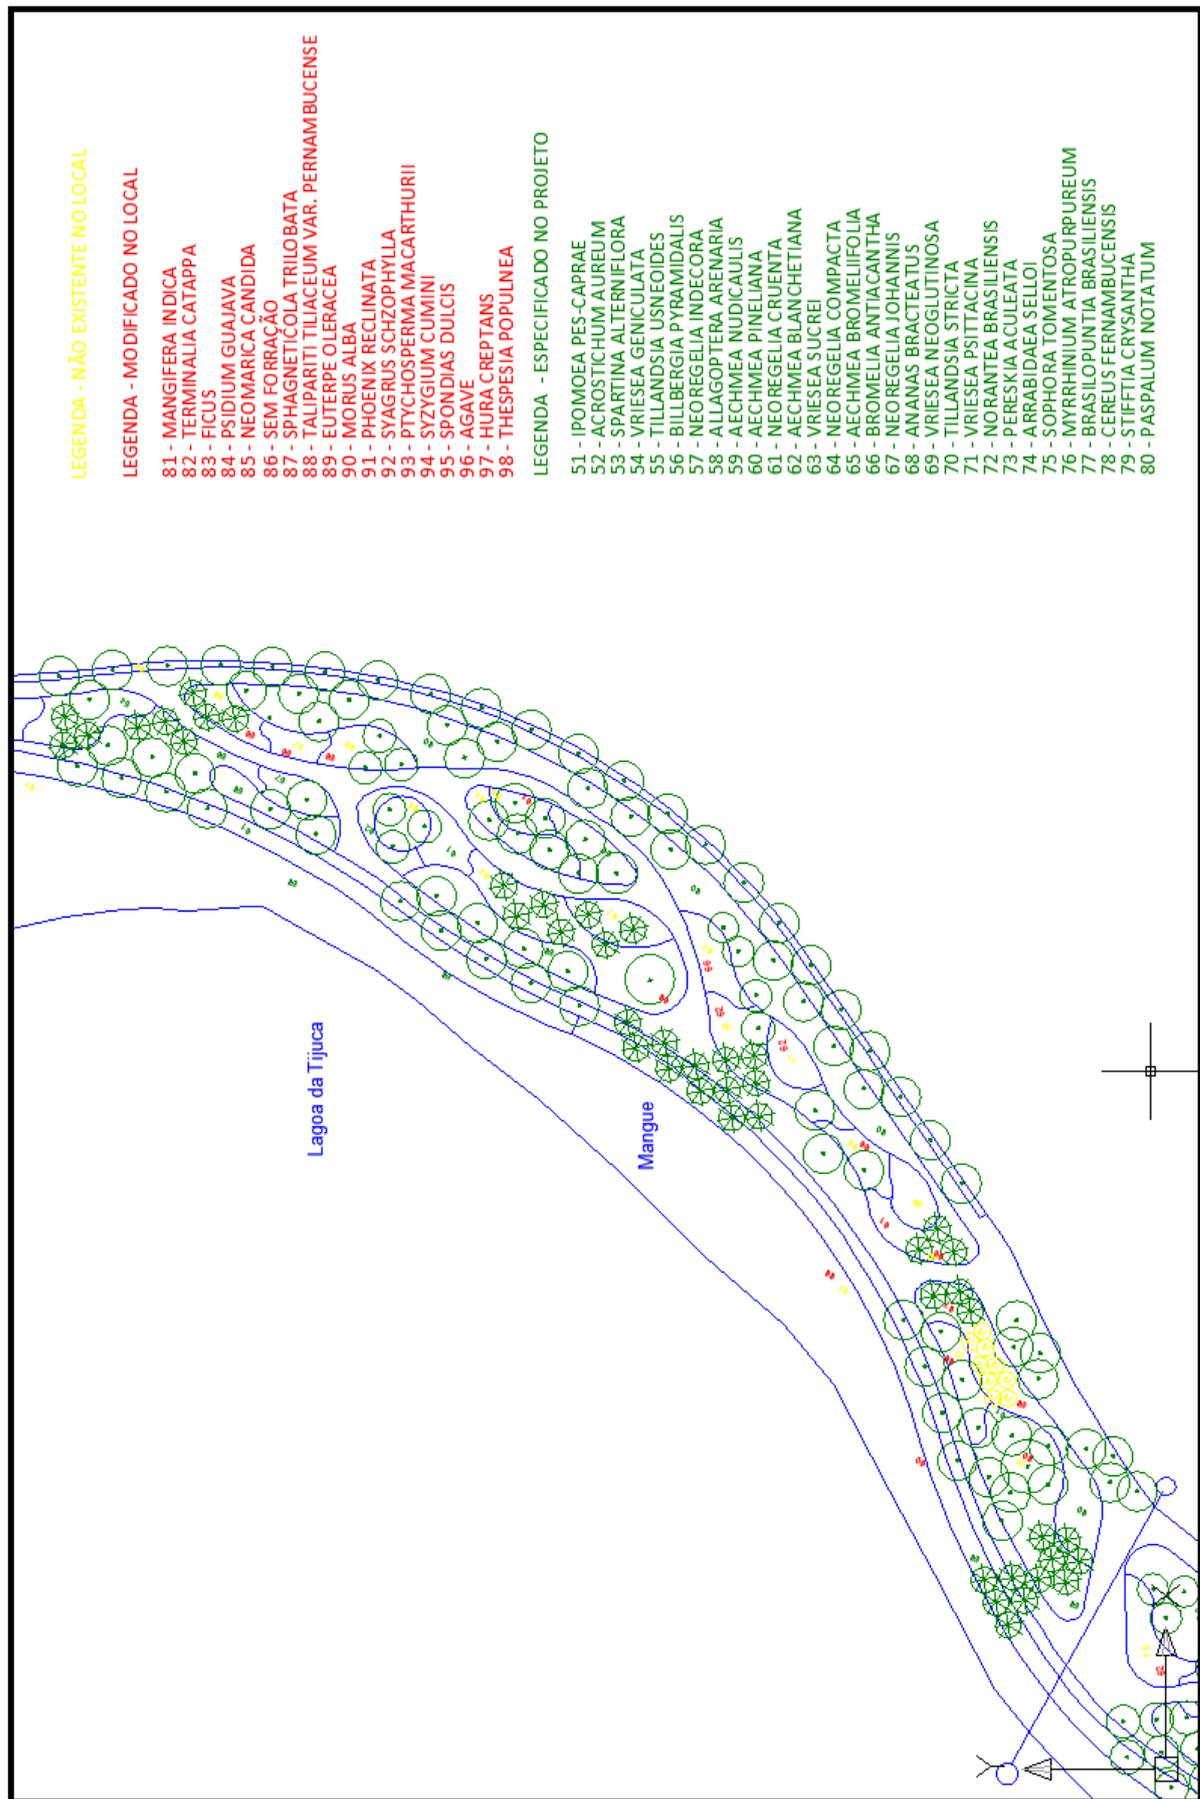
/ Prancha 06 – Planta de Levantamento da Composição Paisagística – cobertura vegetal - autora
